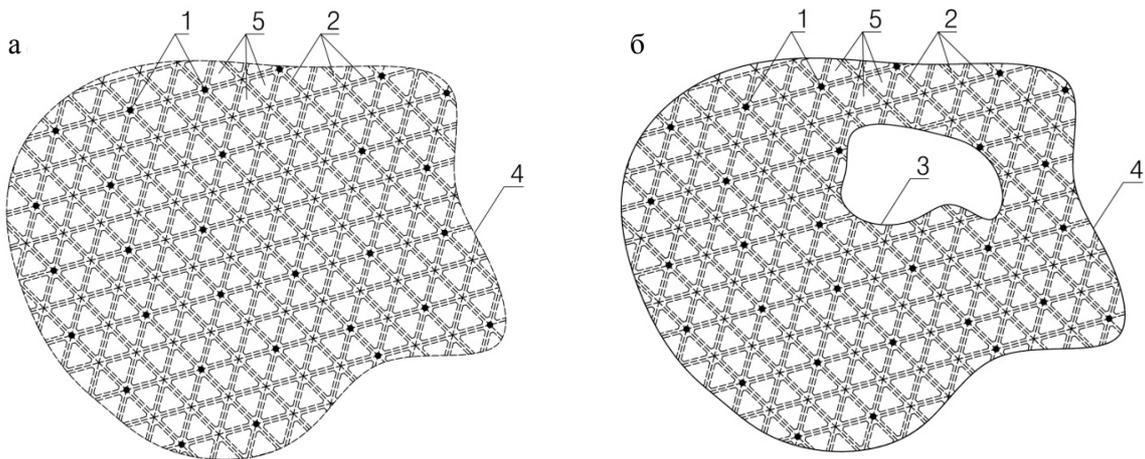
Конструкция фундаментной плиты и плиты перекрытия: а – фундаментная плита; б – плита перекрытия; 1 – колонны; 2 – внутренние ребра жесткости плиты перекрытия; 3 – внутренняя окантовка ребром жесткости; 4 – внешняя окантовка ребром жесткости; 5 – вкладыши
